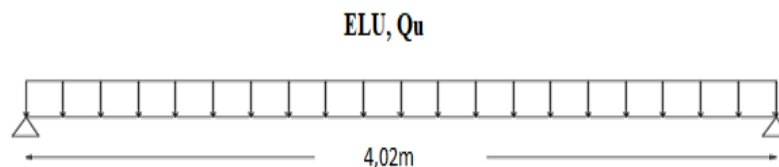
Schéma statique de la poutrelle à 1 travée.
